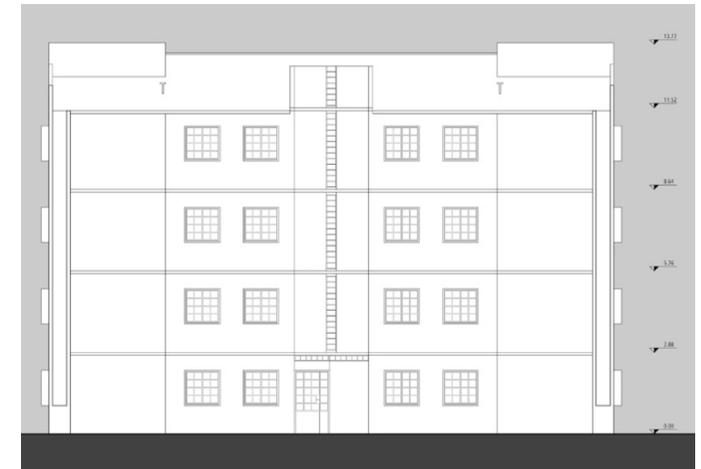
Vista de fachada da entrada do edifício do Conj. Cazuzu.
